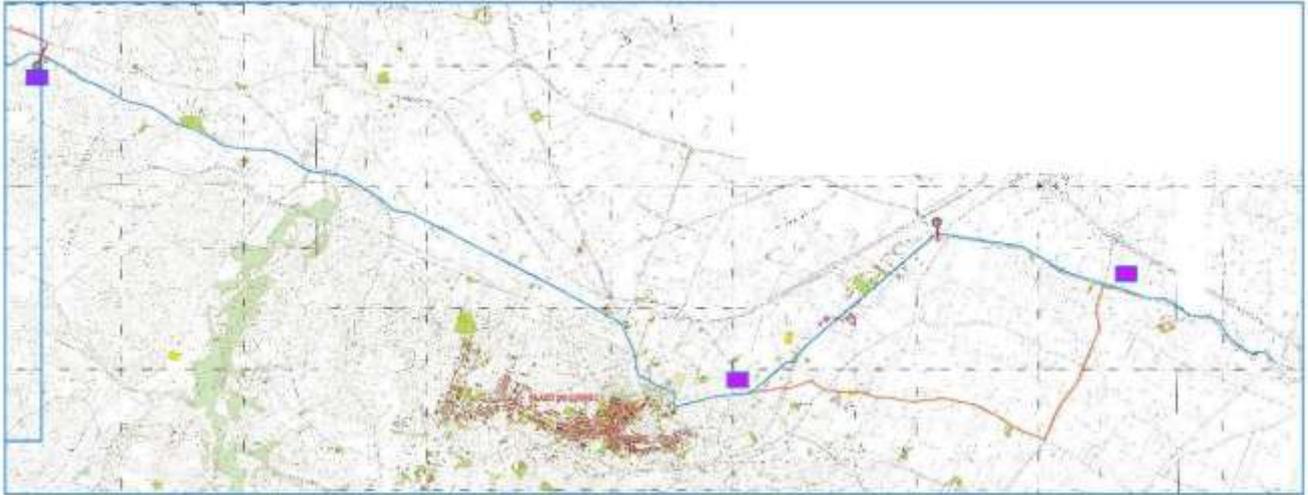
Tracciato planimetrico del Tratto 4.4 della Ciclovía.
